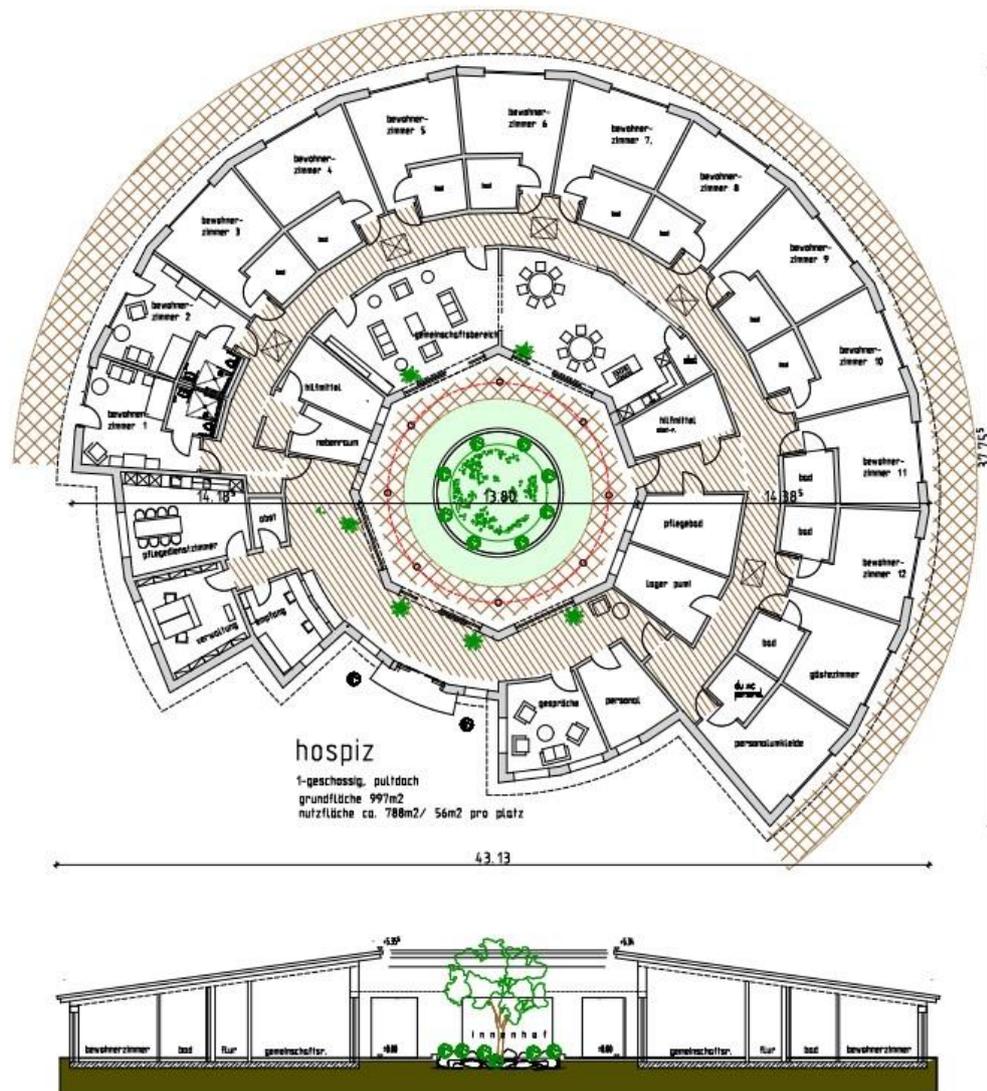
Hospiz: Grundriss und Schnitt
